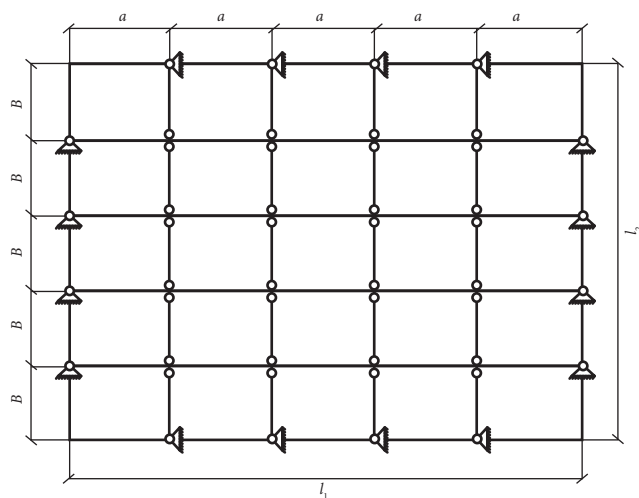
Расчетная схема перекрестной системы покрытия, состоящая из главных и второстепенных балок
